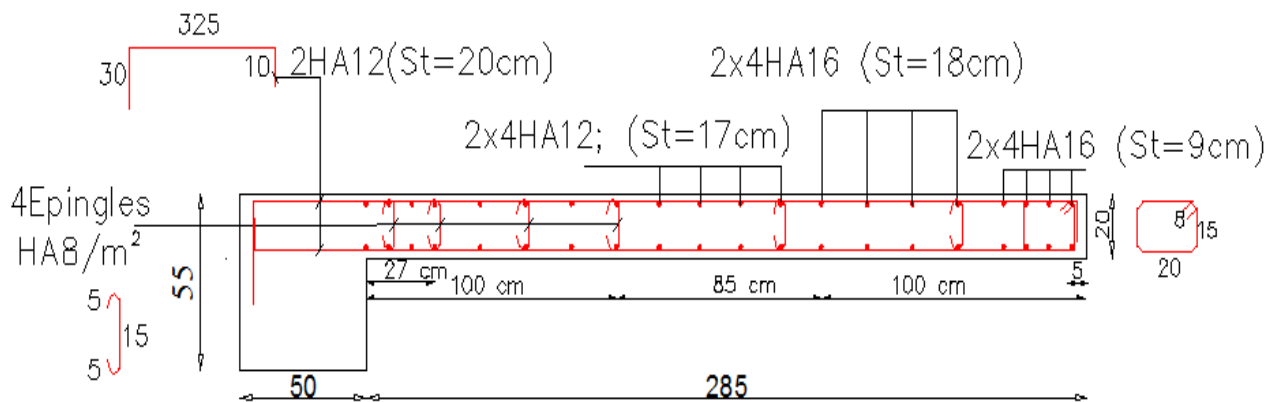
Schéma de ferrailage du Voile V_{y3} (niveau R.D.C)
